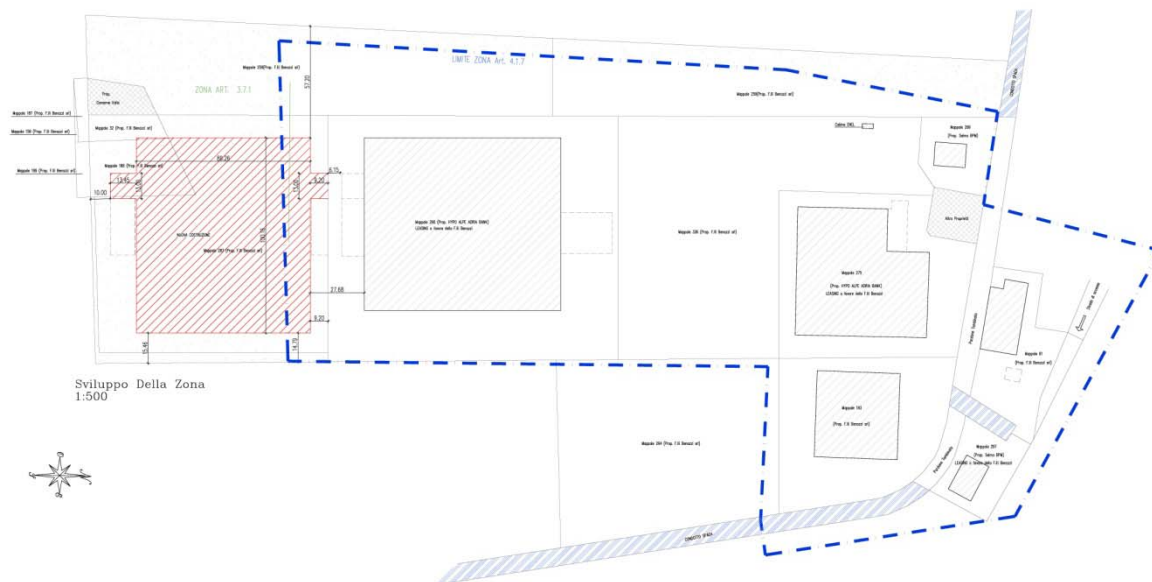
Planimetria del progetto di realizzazione dell'ampliamento.
